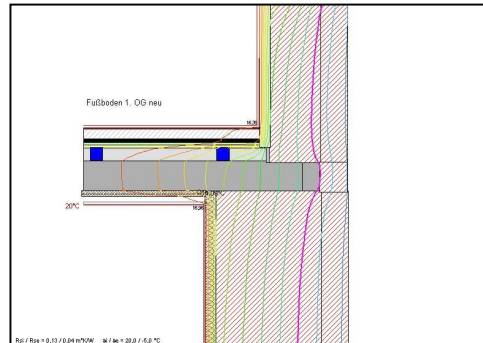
Wärmebrücken-simulations-berechnung einbindende Decke Erdgeschoss
